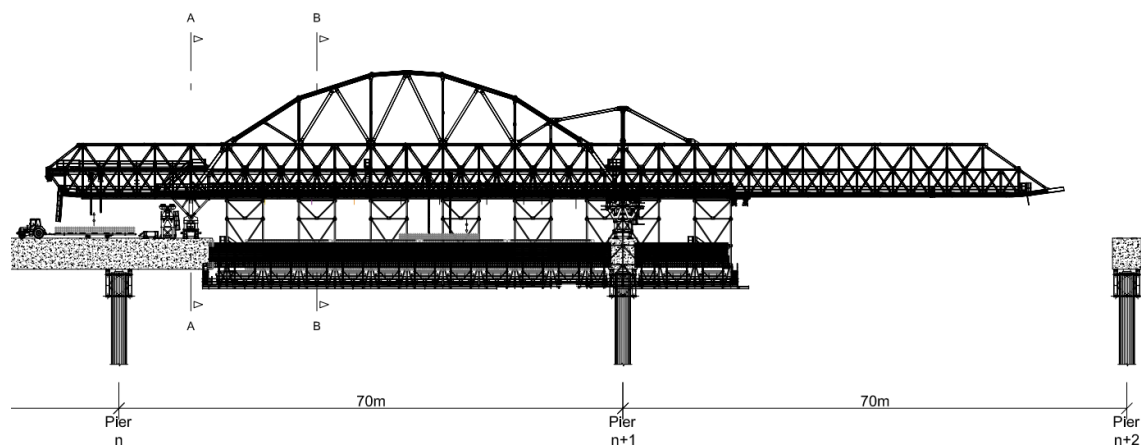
Posicionamento dos pórticos durante a betonagem.
